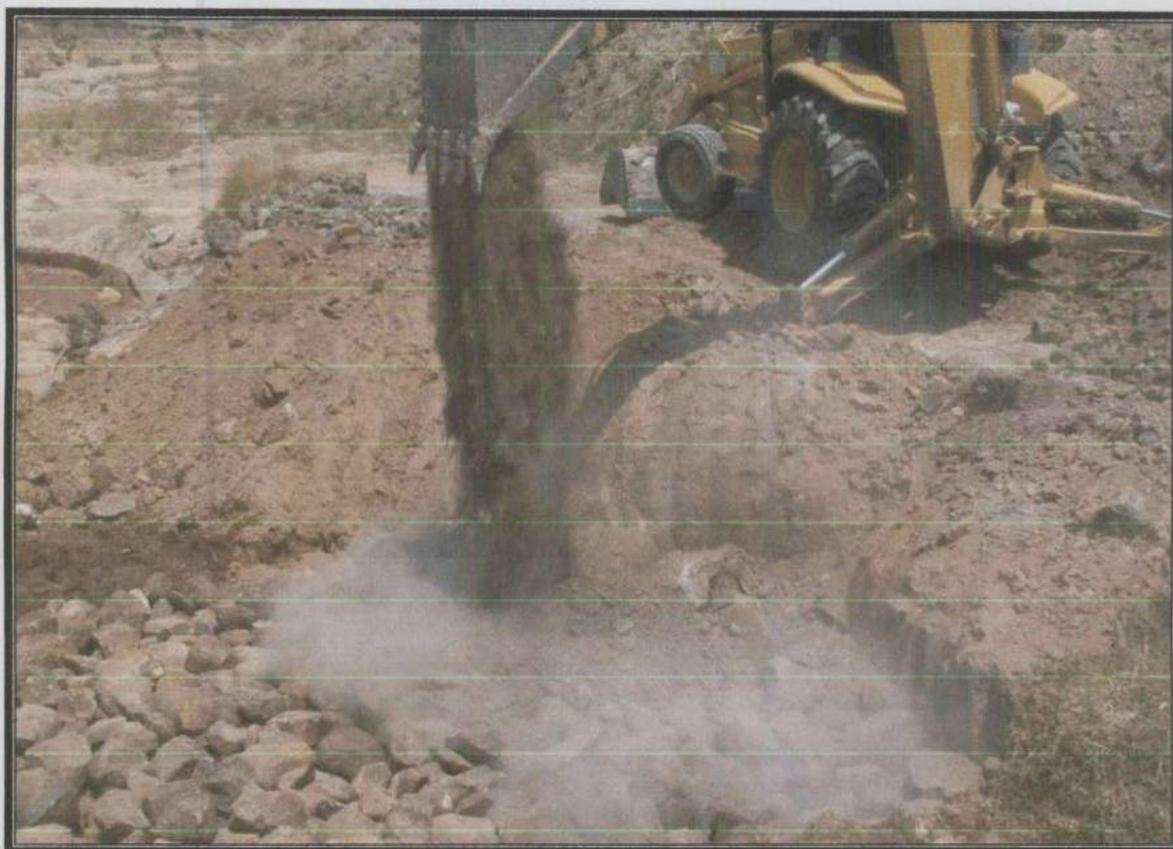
Corrección del piso del cauce de la Sección Hidráulica de la Sección Arturo
